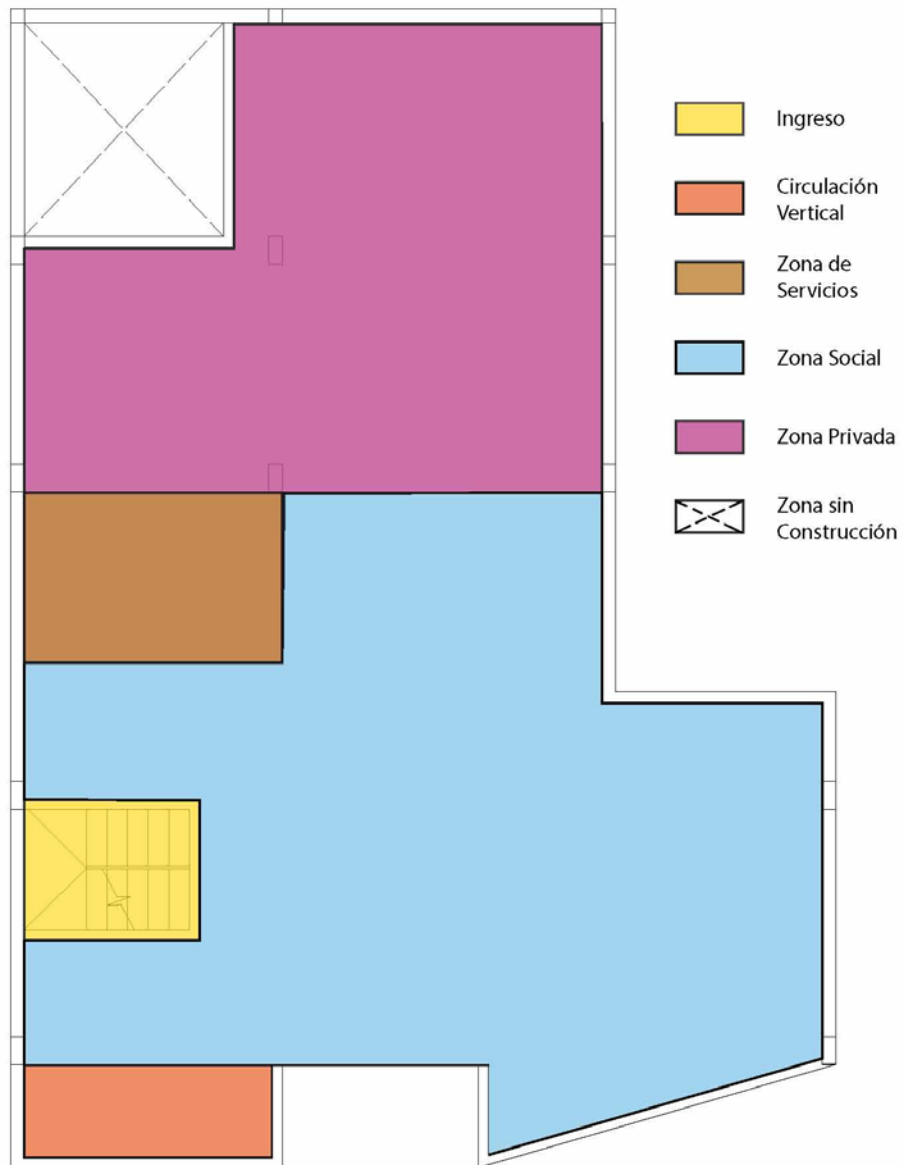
Zonificación de la vivienda 1er nivel - Fuente: Autoría propia
